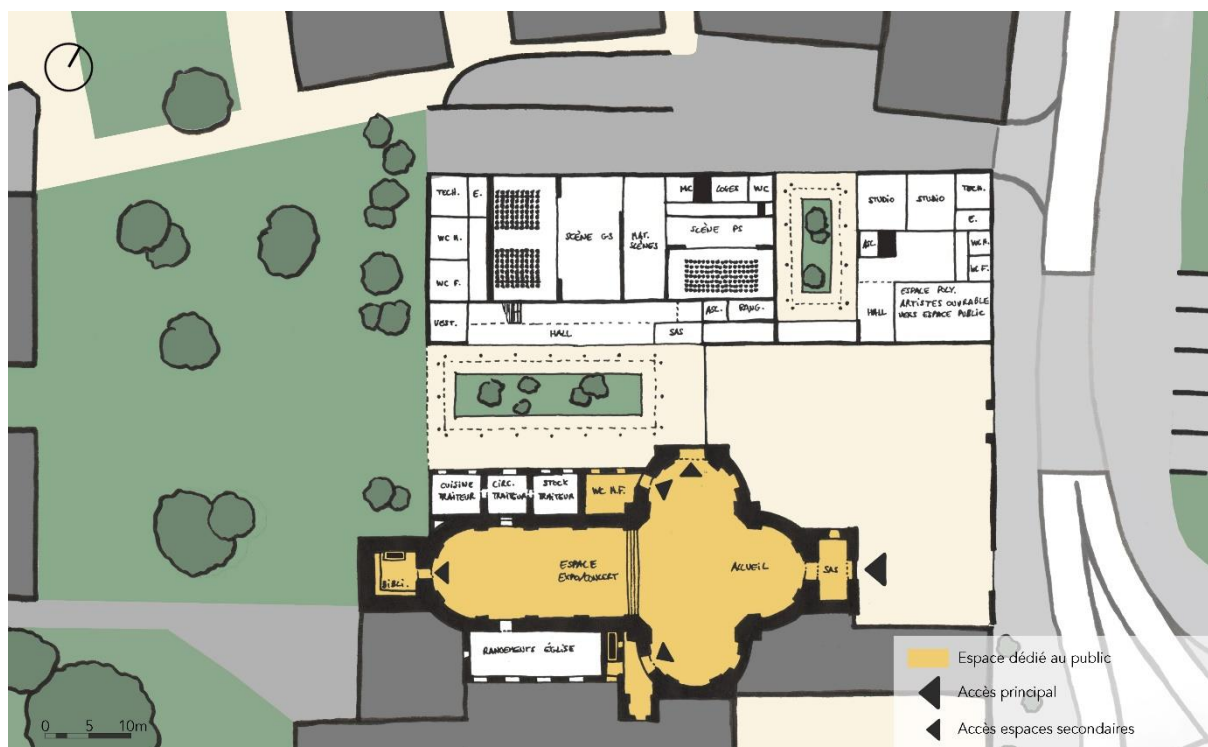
Distribution des accès possibles depuis le RDC de l'église (fond de plan WalOnMap, 2016)
